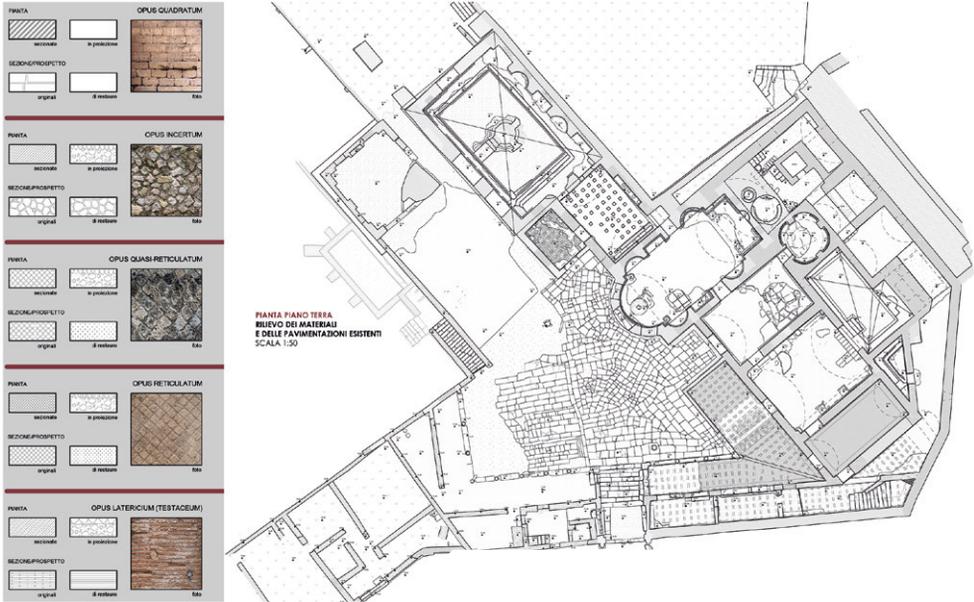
Planimetria e analisi mensiocronologica delle murature site nelle Terme Suburbane di Pompei.
